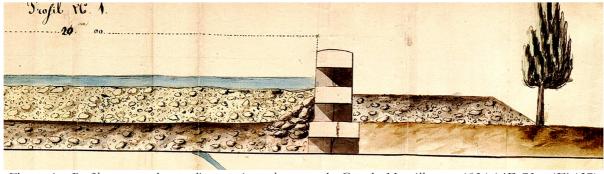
Profil en travers du mur digue protégeant la « route des Grandes Murailles », v. 1824 (AD 73 – 1Fi 127)
